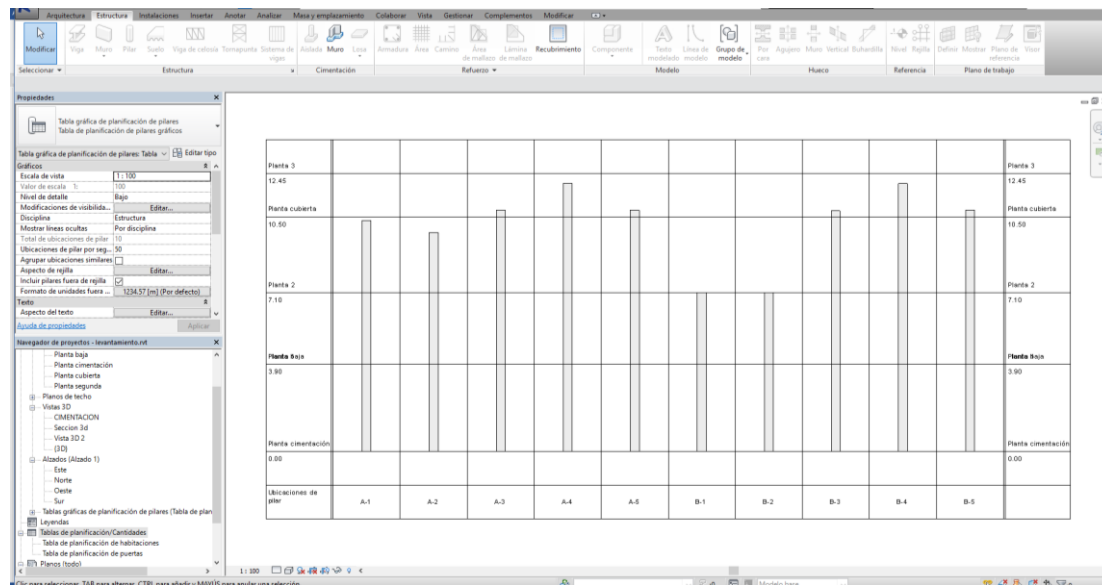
Tabla de planificación de pilares. Fuente: Elaboración propia
